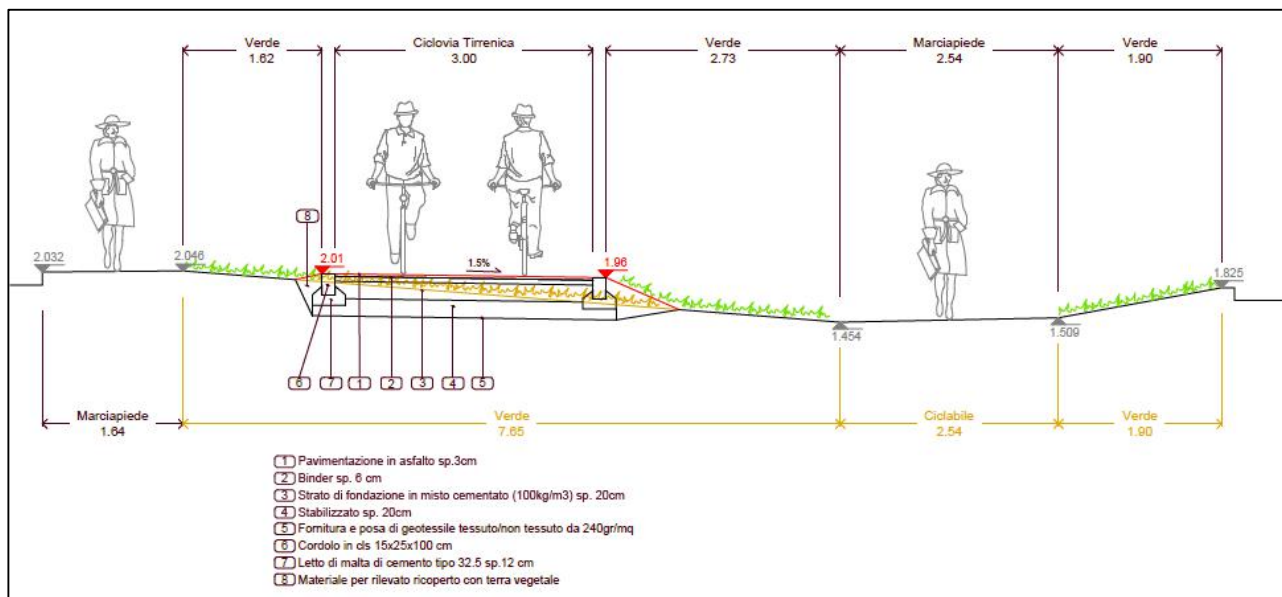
Sezione 11 di progetto trasversale SP delle Collacchie
